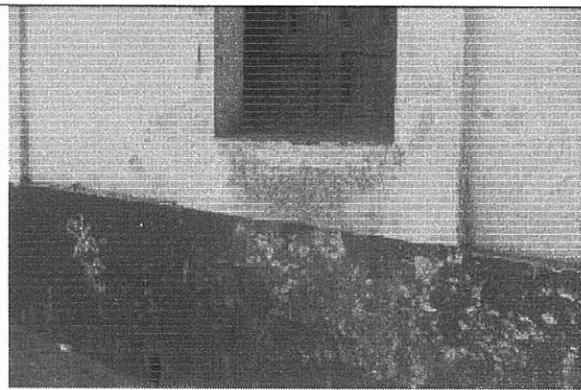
Humedad y deterioro en muro de fachada del costado oriental
